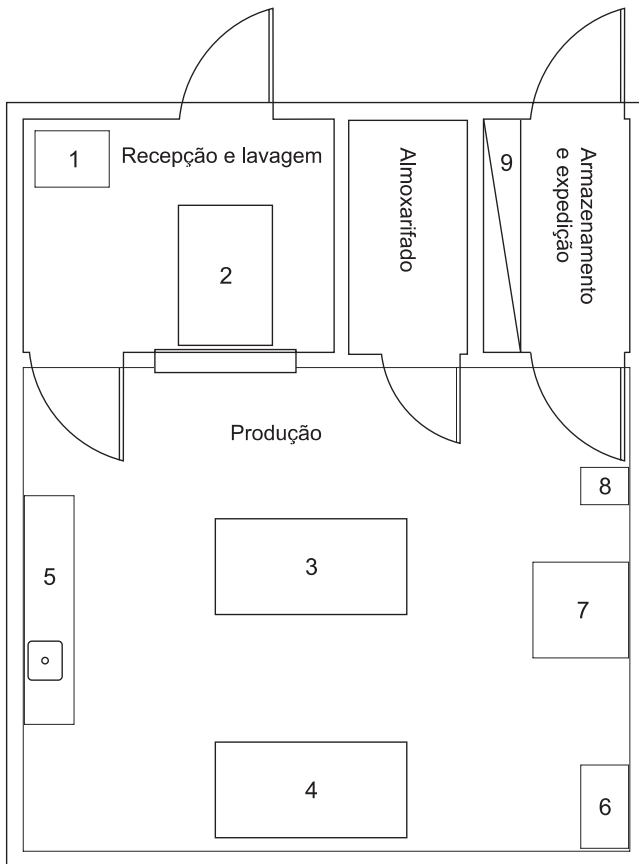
Planta baixa da agroindústria de processamento de frutas desidratadas.
